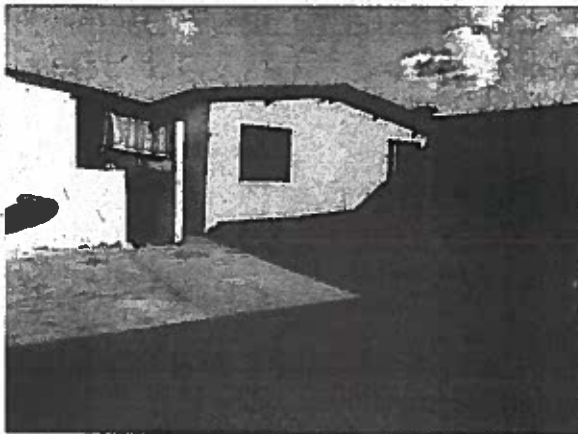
Casa principal e Edícula lateral (vista frontal)
